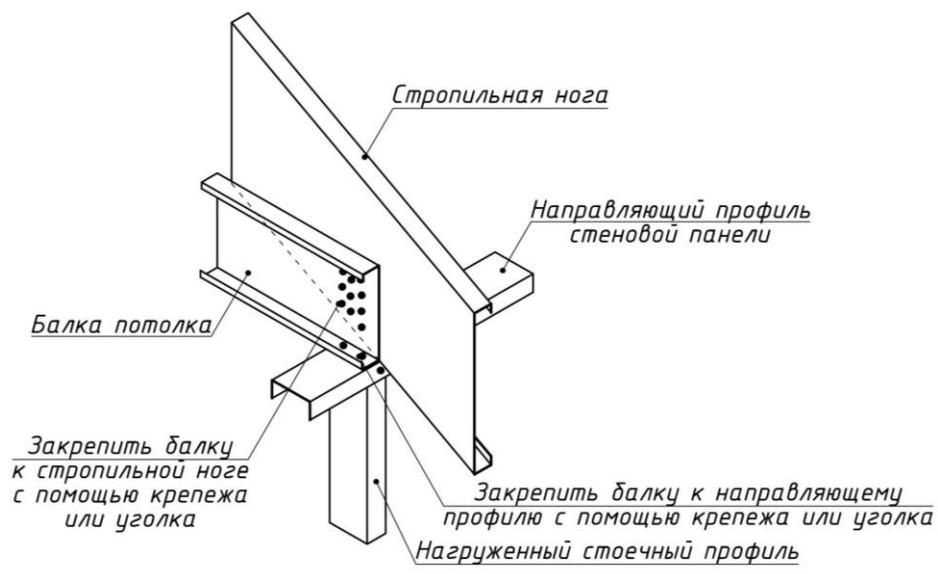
Узел К 4. Крепление балки к стропильной ноге
